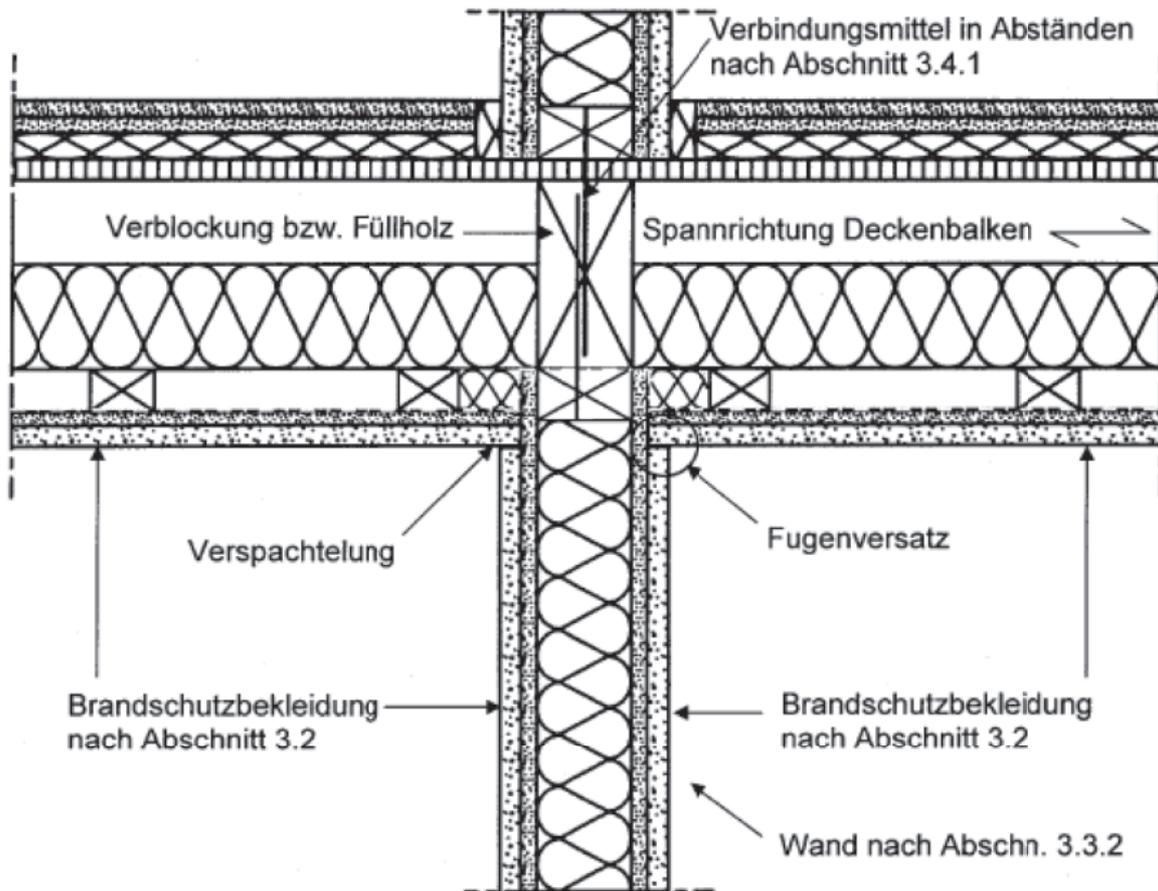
Anschluss tragende und raumabschließende Wand nach Abschn. 3.3.2 an Decke nach Abschn. 3.3.3 (Spannrichtung der Deckenbalken senkrecht zur Wand)
